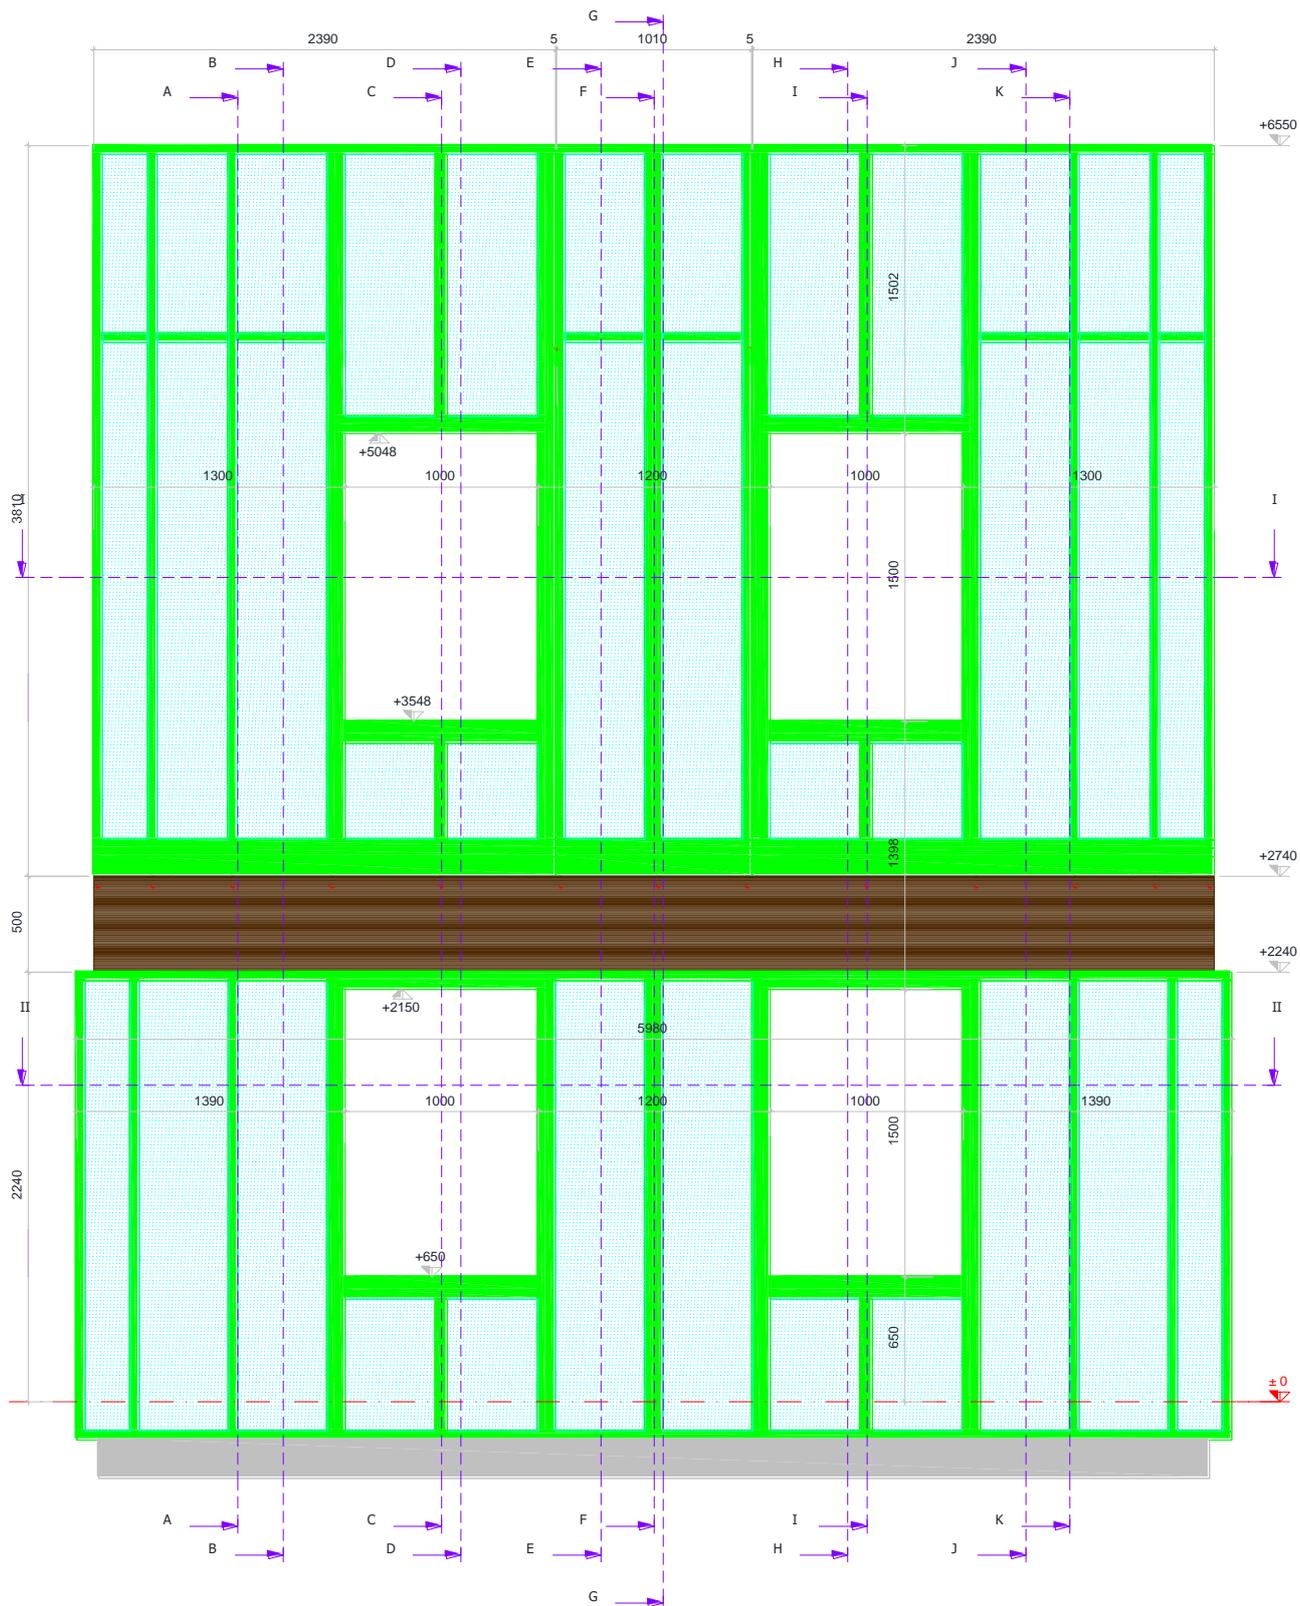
Instrumentation de l'élément de façade - Vue des coupes sur l'élévation d'ossature
